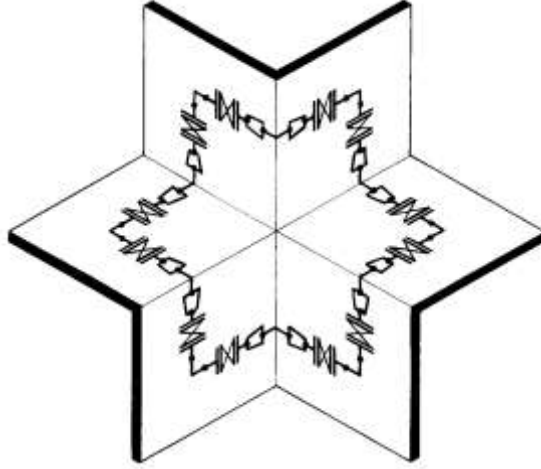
Boru tarafsız eksen ölçülerinin izometrik düzleme taşınması
